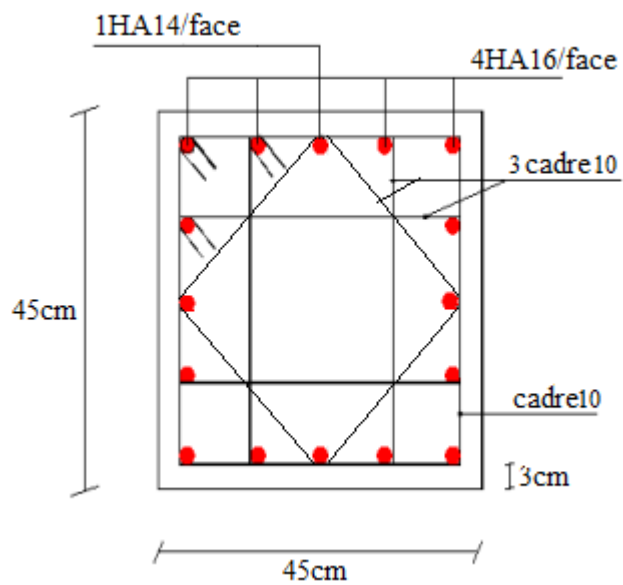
Schéma de ferraillage poteaux 6^{ème} étage+7^{ème} étage
